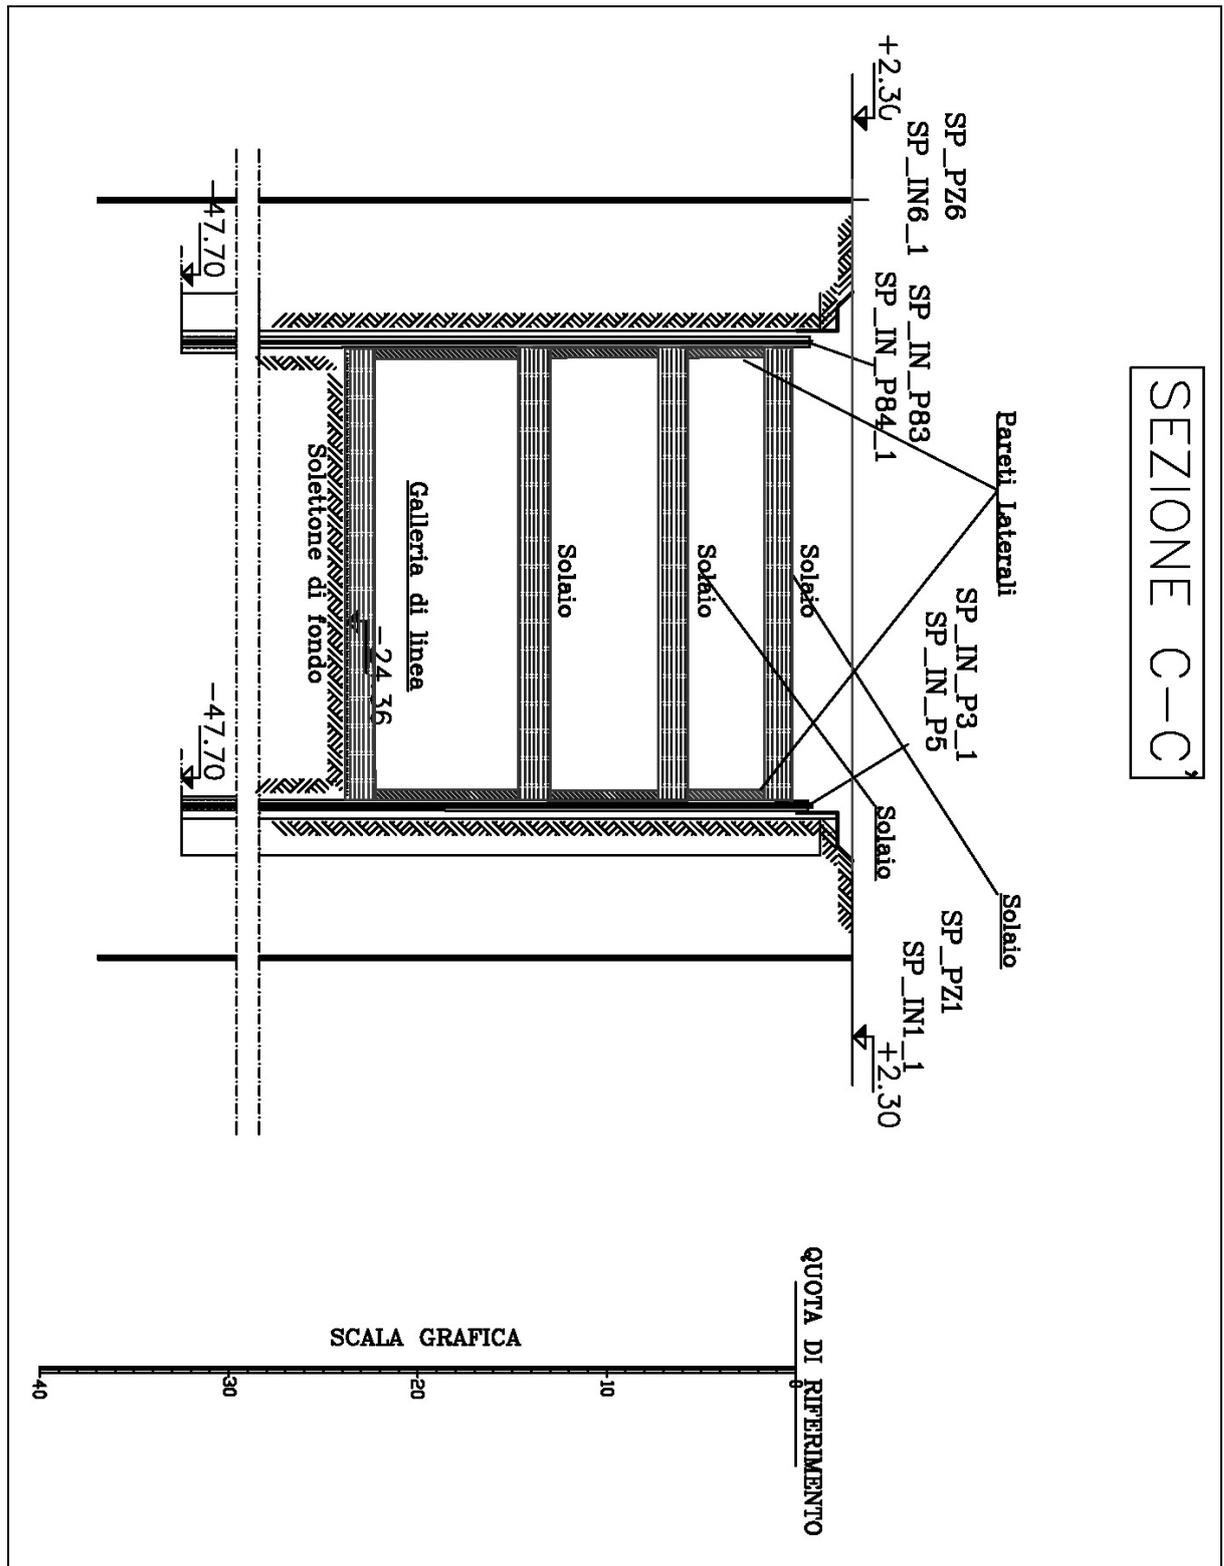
Sezione C-C' pozzo stazione, raffigurante la suddivisione in aree di lavoro.
